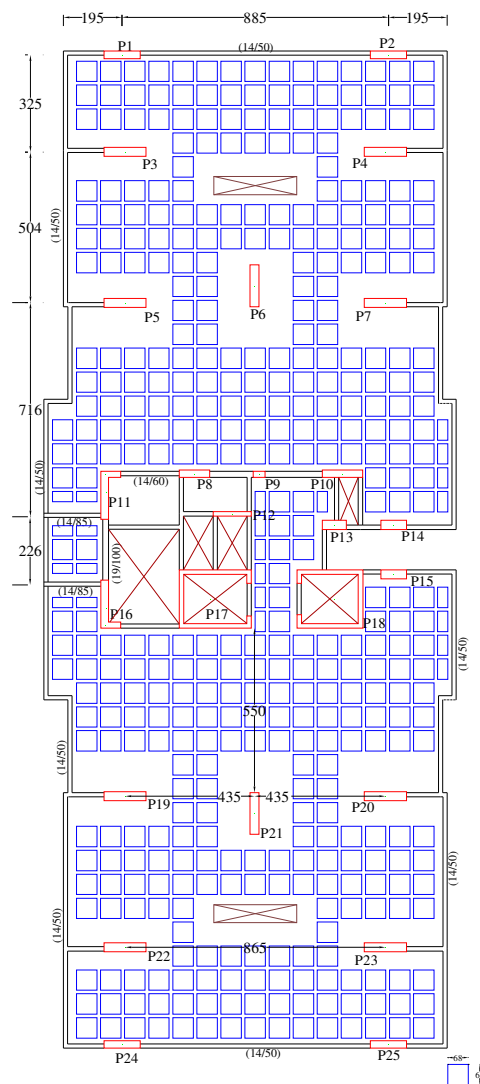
Planta baixa do pavimento tipo do terceiro exemplo
